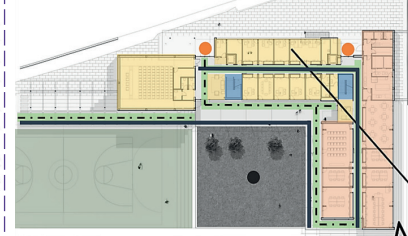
Planimetría, Proyecto Hombre Fuente: (Gabriela Ríos, 2021)
